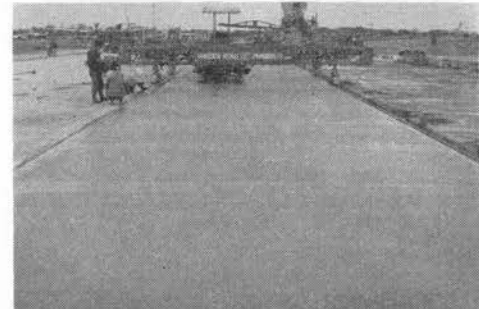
コンクリートレベリングフィニッシャ丸善舗道
